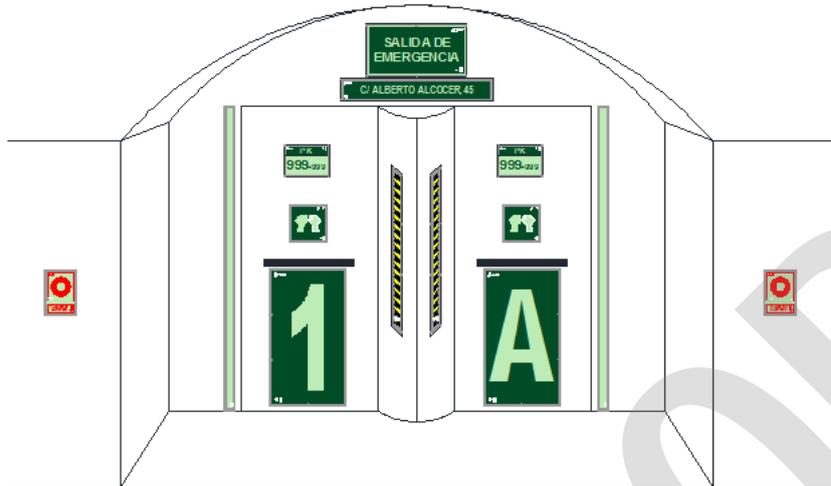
Elementos a instalar en salida de emergencia de 2 puertas con tabique redondeado de separación.
